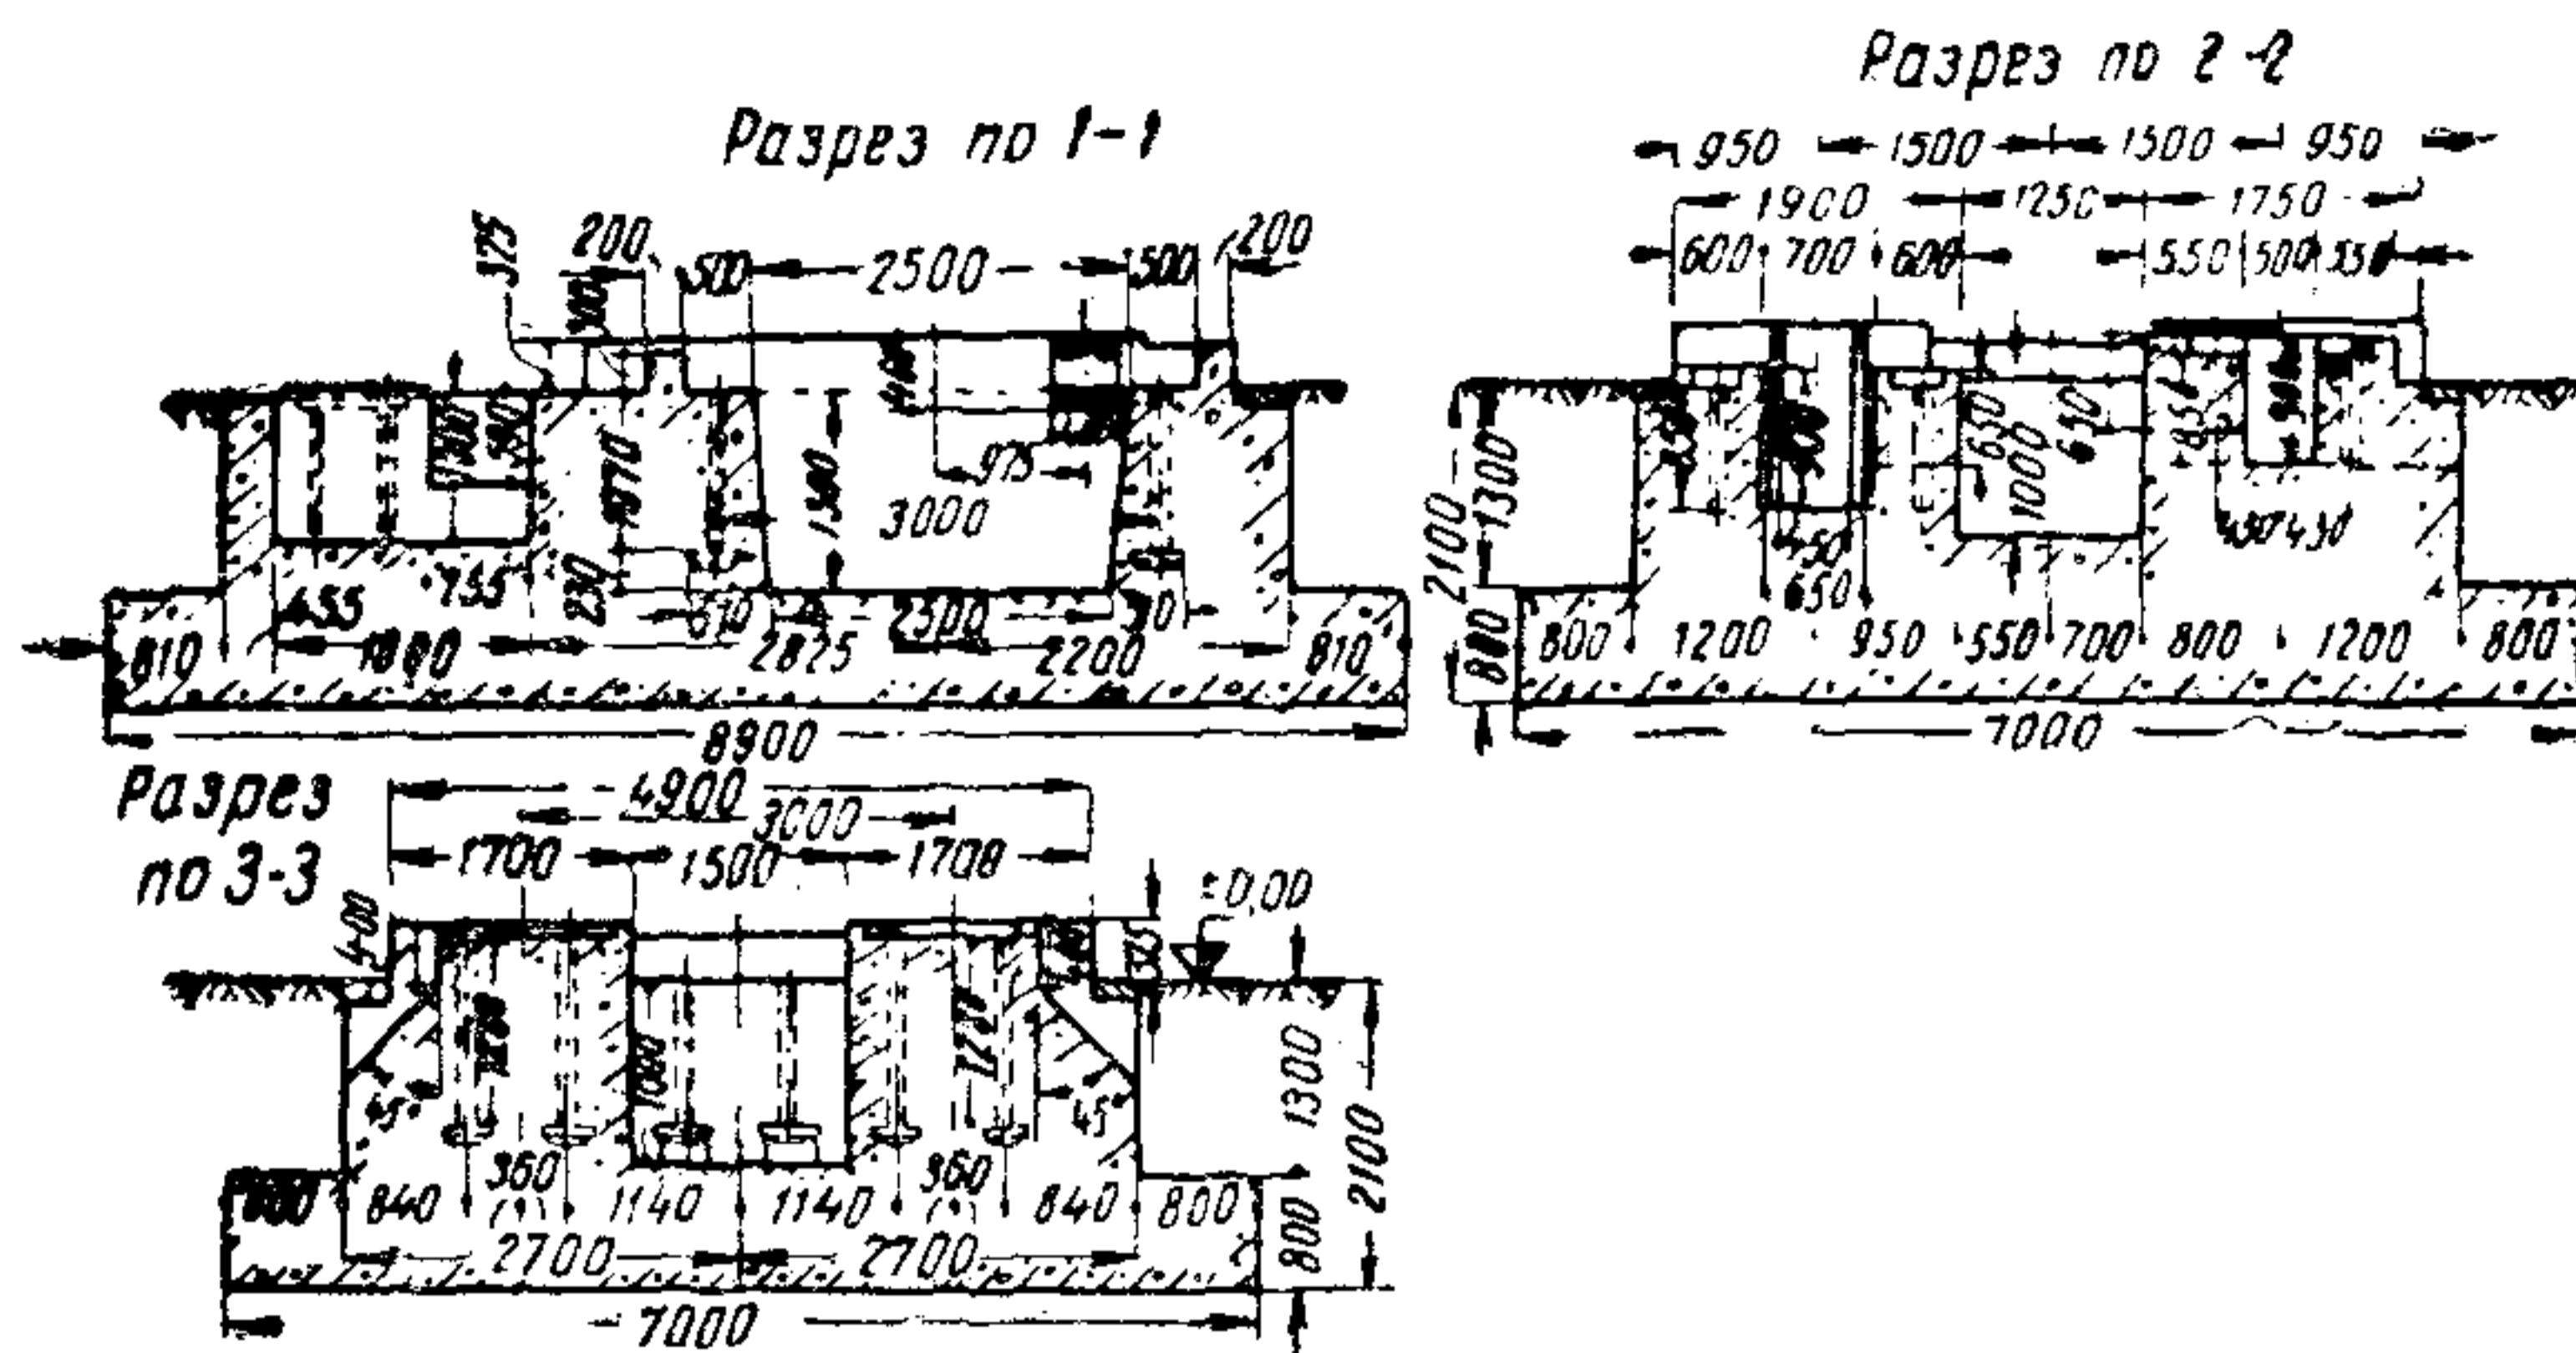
Конструкция и размеры фундамента под поршневой двухцилиндровый горизонтальный компрессор 2ВГ (разрезы—см. рис. 1)
